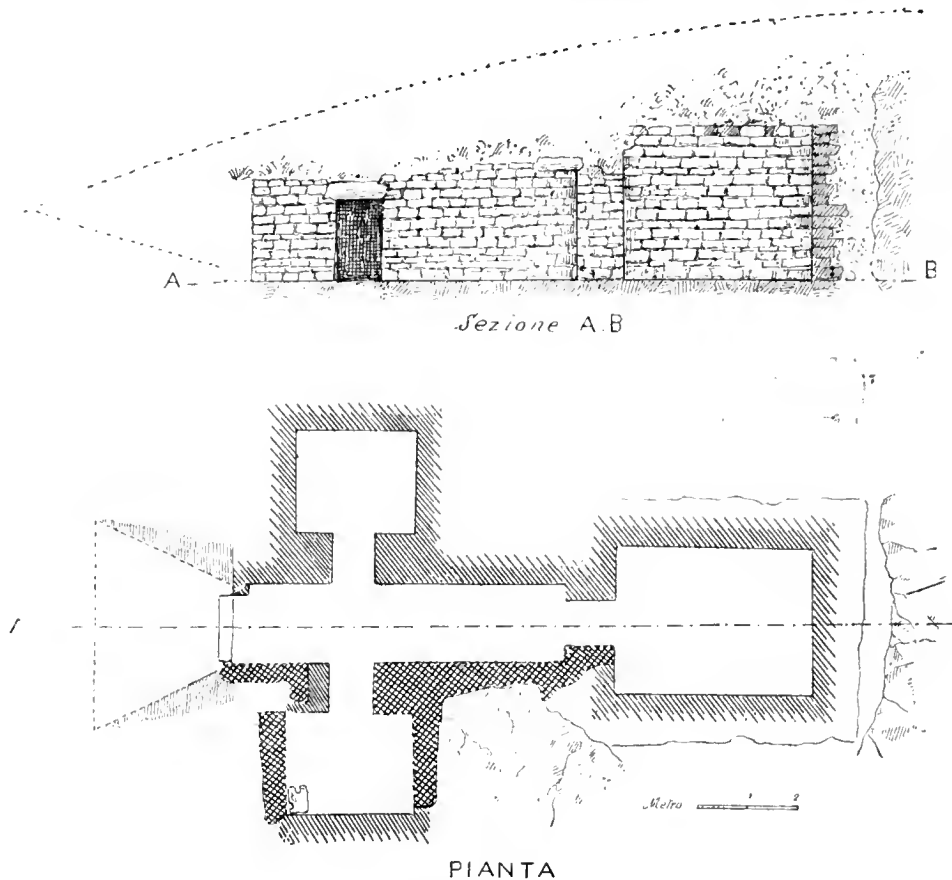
Pianta e sezione dell'ipogeo meridionale.
